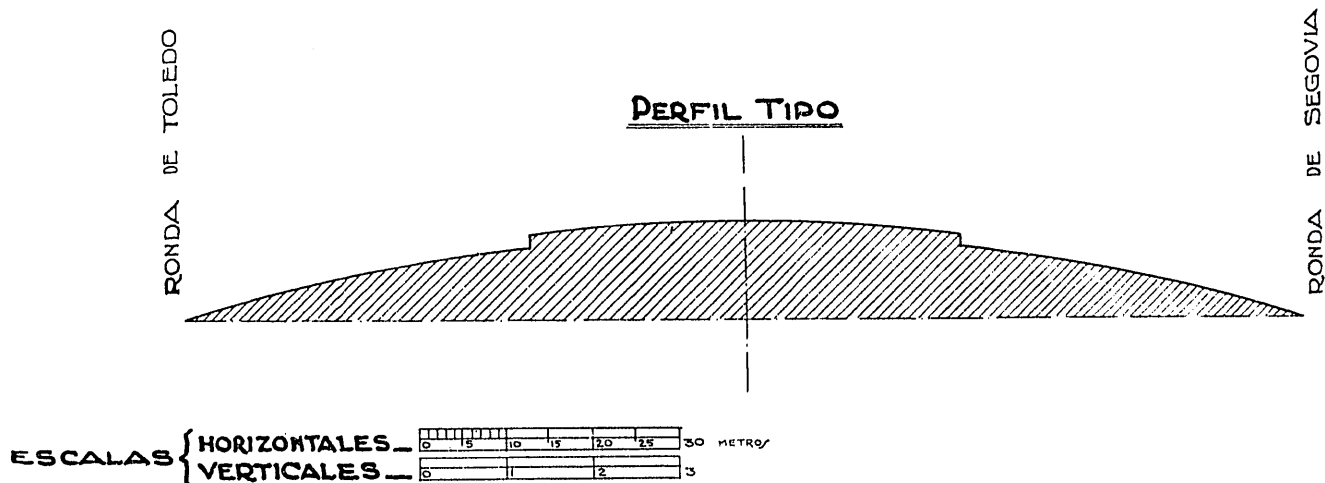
Perfil transversal tipo actual de la Glorieta de la Puerta de Toledo
